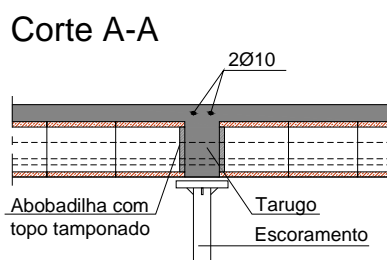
Solução de tarugamento de pavimentos de vigotas
